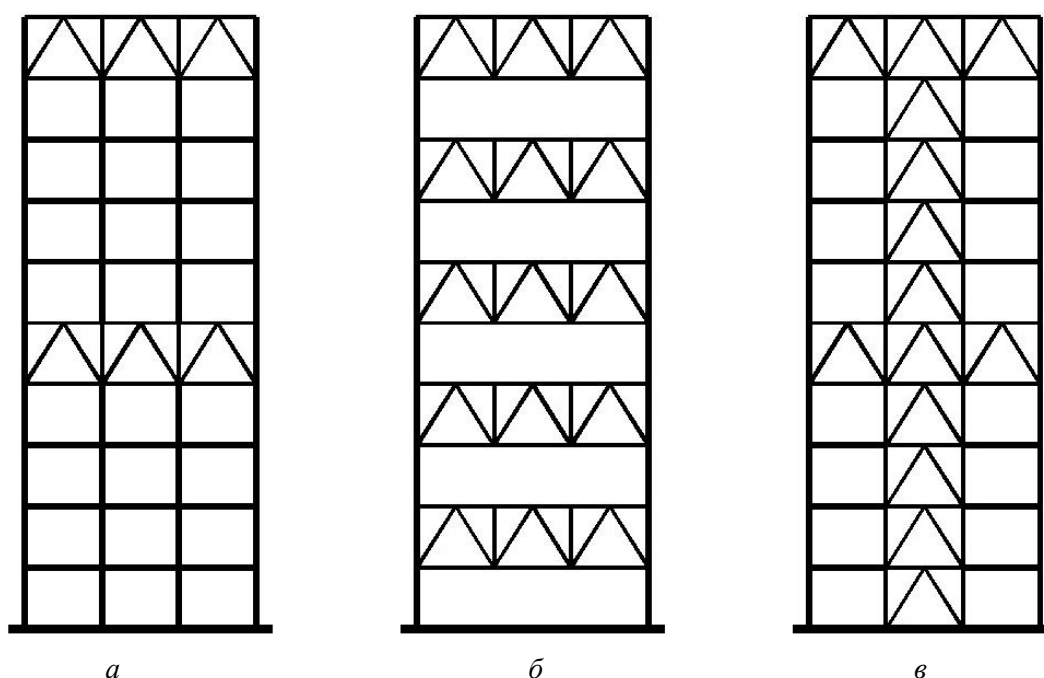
Виды рамно-связевых каркасов: каркасы с фермами-ростверками (а), с фермами-ригелями (б), с фермами-поясами и вертикальными диафрагмами (в)
